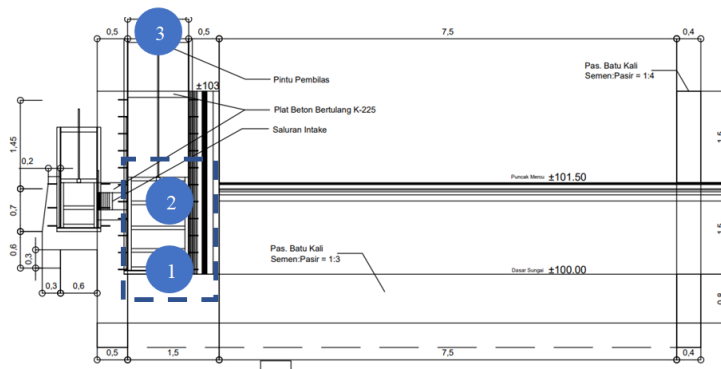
Denah Bendung, Intake, dan Bak Penenang (Koaksi, 2022)
